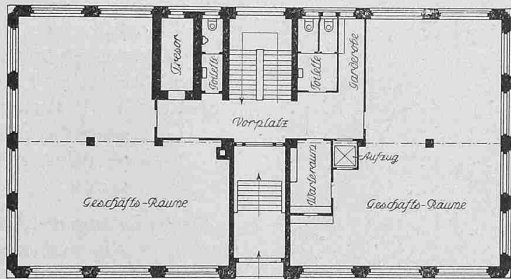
Geschäftshaus J. G. Nef & Cie. — Grundriss 1 : 400.
